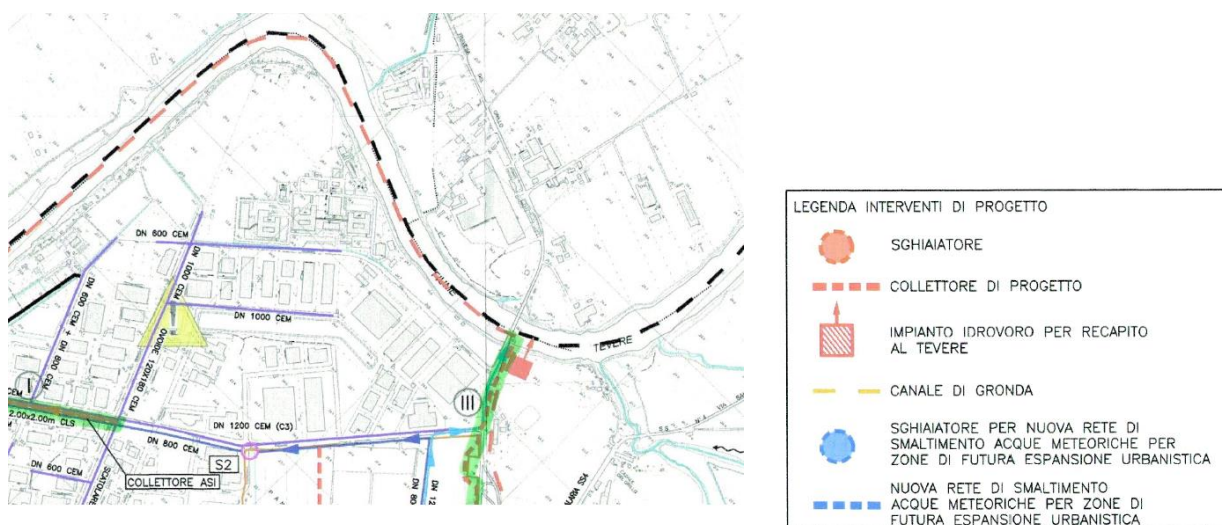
Planimetria POR-FESR Lazio 2014-2020
